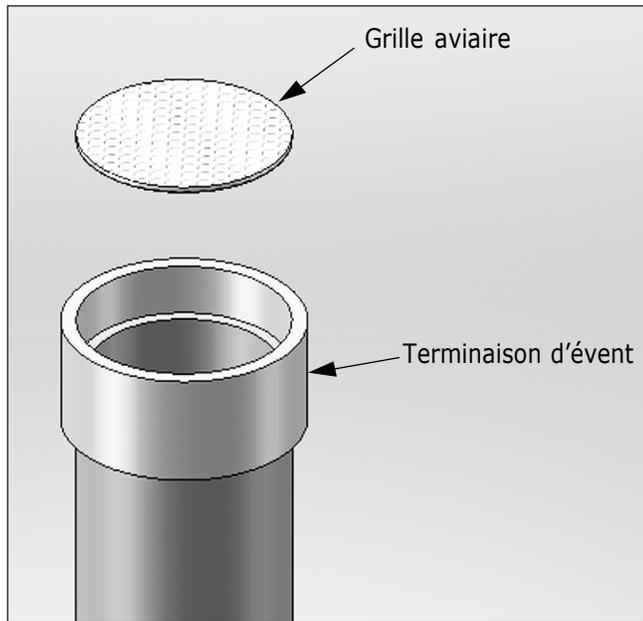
Installation de grille aviaire sur tuyauterie d'évent verticale
